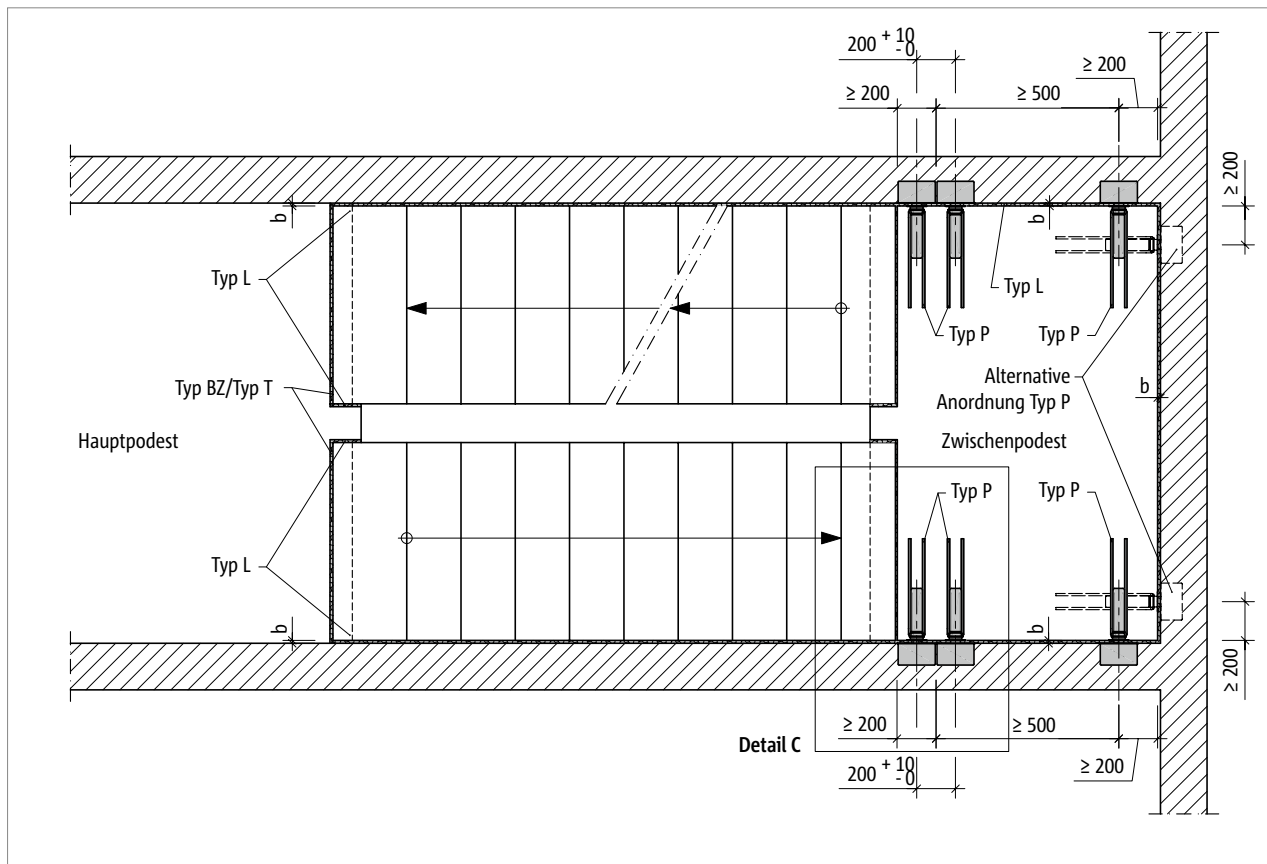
Schöck Tronsole® Typ P (paarweise Anordnung): Elementanordnung, Detail C, Fugenbreite  $b = 15 \text{ mm}$  bei Ortbeton, bei Elementtreppentläufen ist die Notwendigkeit einer zusätzlichen Einbautoleranz durch den Planer zu prüfen
